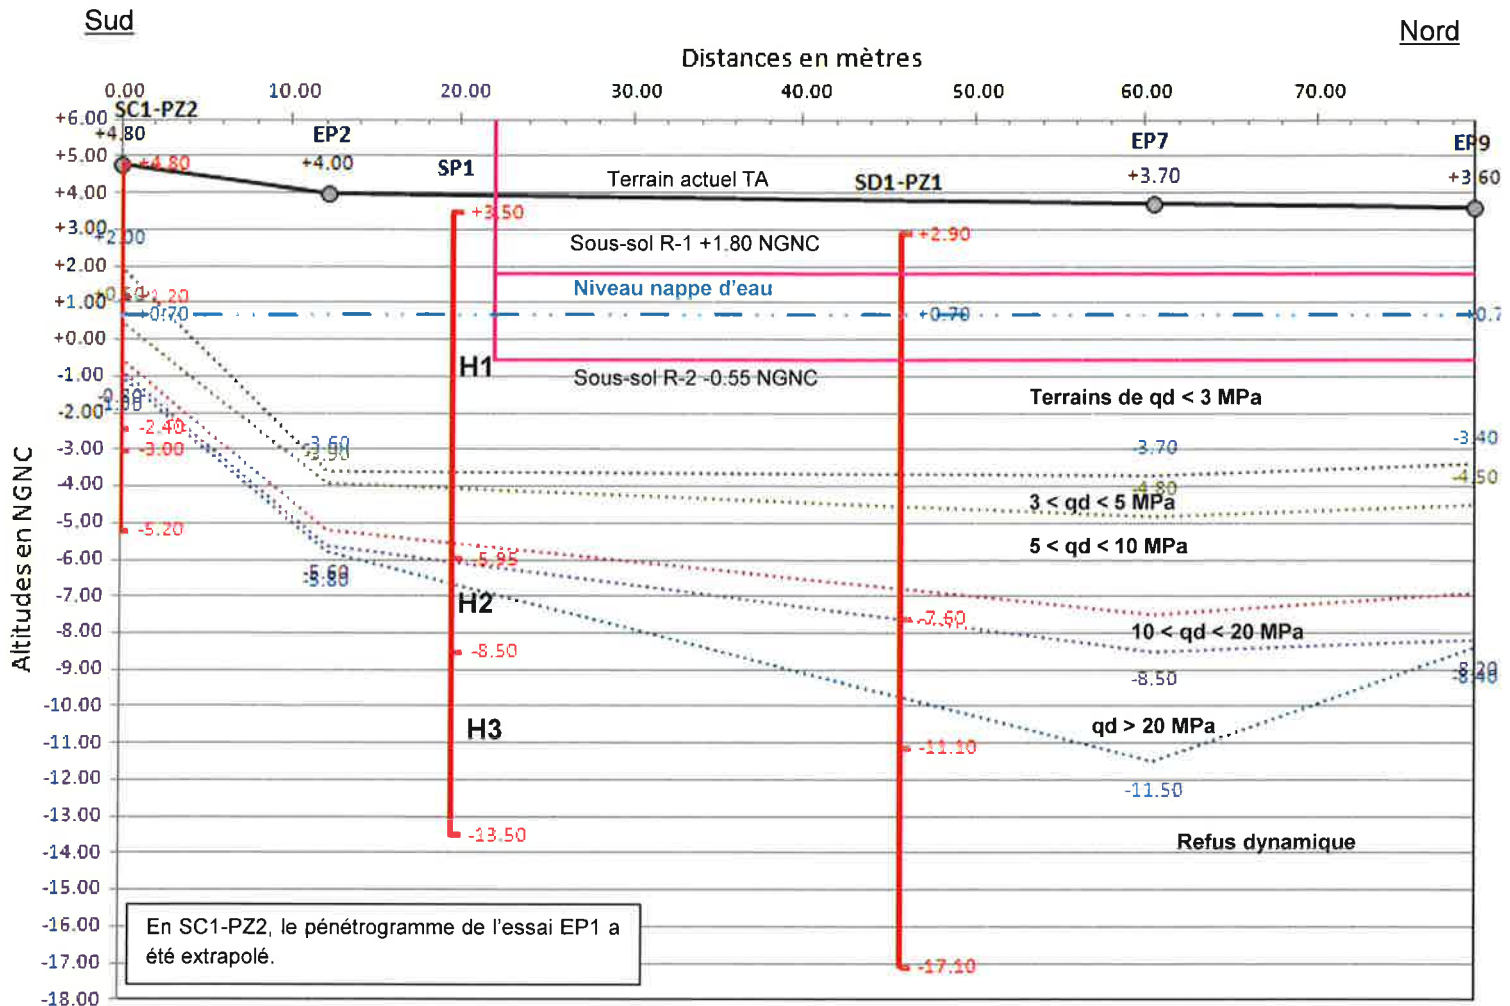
Coupe synthétique Nord-Sud entre SC1-PZ2-EP2-EP7 et EP9
